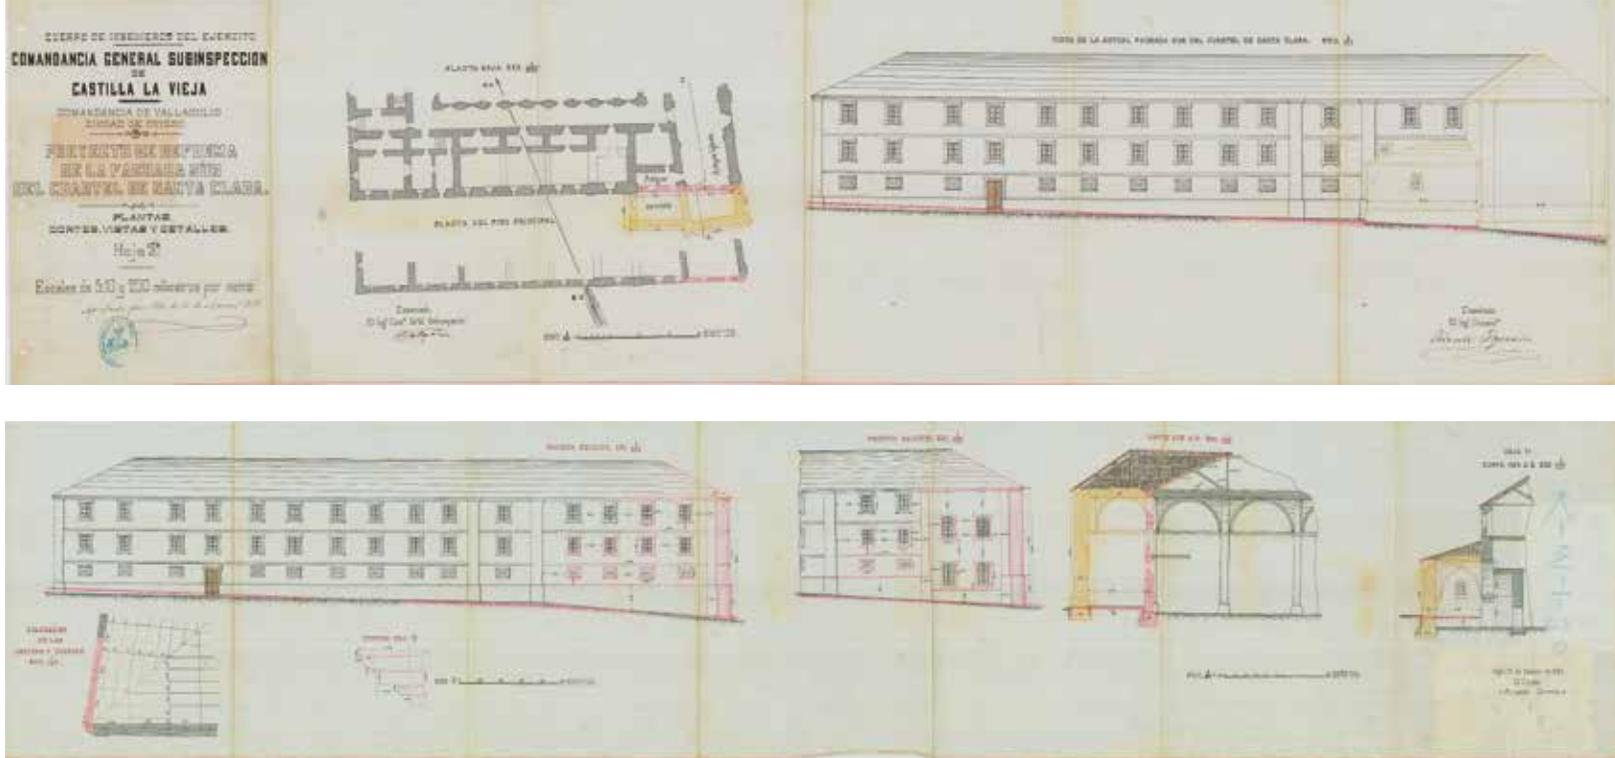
Plano, alzados y secciones del proyecto de reforma de la fachada este del convento en 1886 (AGMM, O-03-09).
